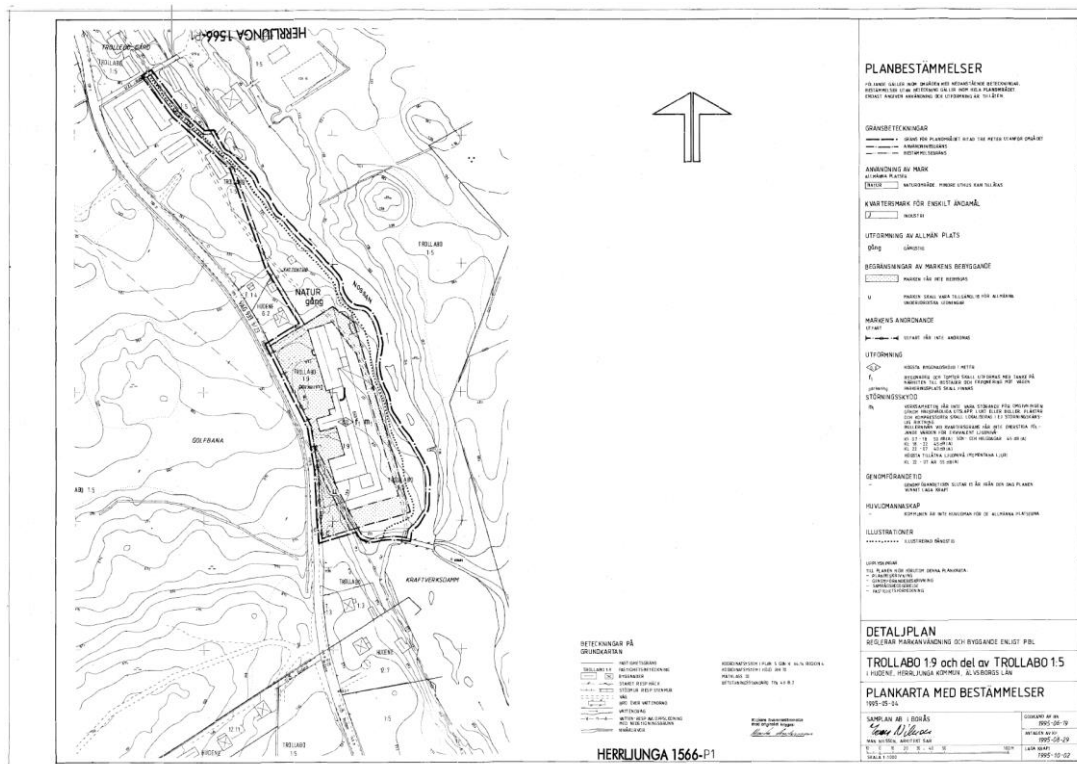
Gällande detaljplan, 1566-P1, detaljplan för Trollabo 1:9 och del av Trollabo 1:5.
